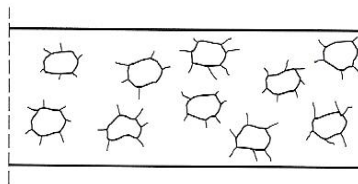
Fisuración interna en la retracción por secado (Fernández Cánovas, 1994)
